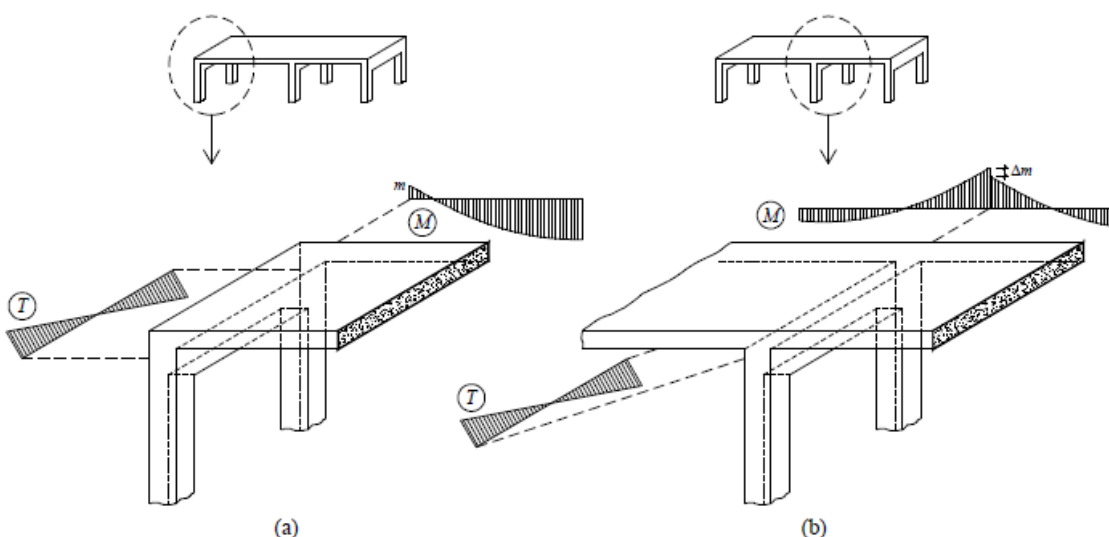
Apoio de uma laje de pavimento em vigas de extremidade e de continuidade [9]
